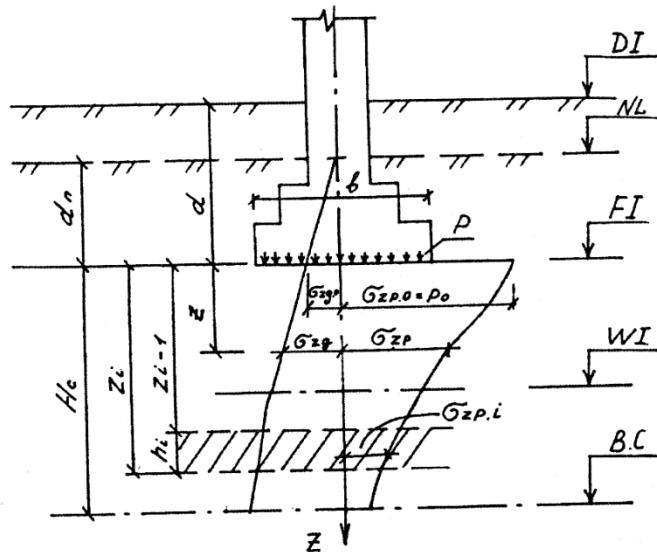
Схема распределения вертикальных напряжений в основании при расчете осадки методом послойного суммирования
